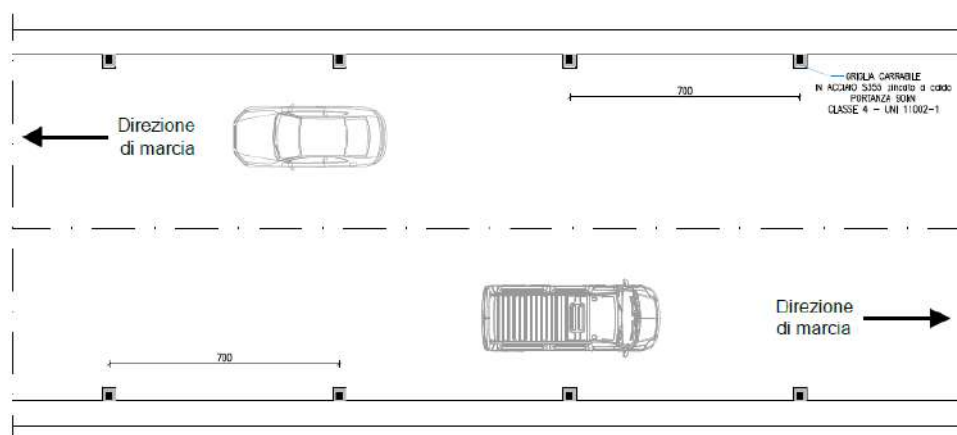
Distribuzione planimetrica bocchette di scarico
